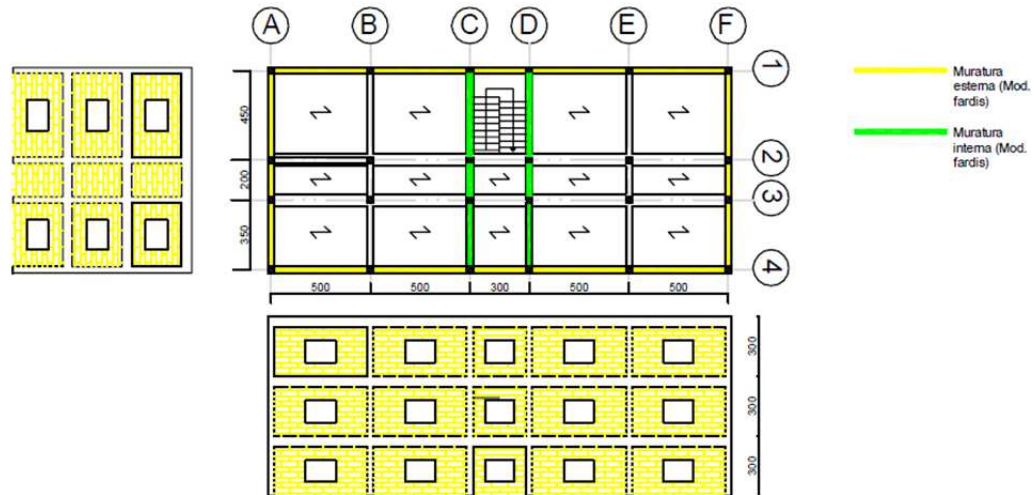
Pianta strutturale con rappresentazione delle tamponature per il caso studio in esame
